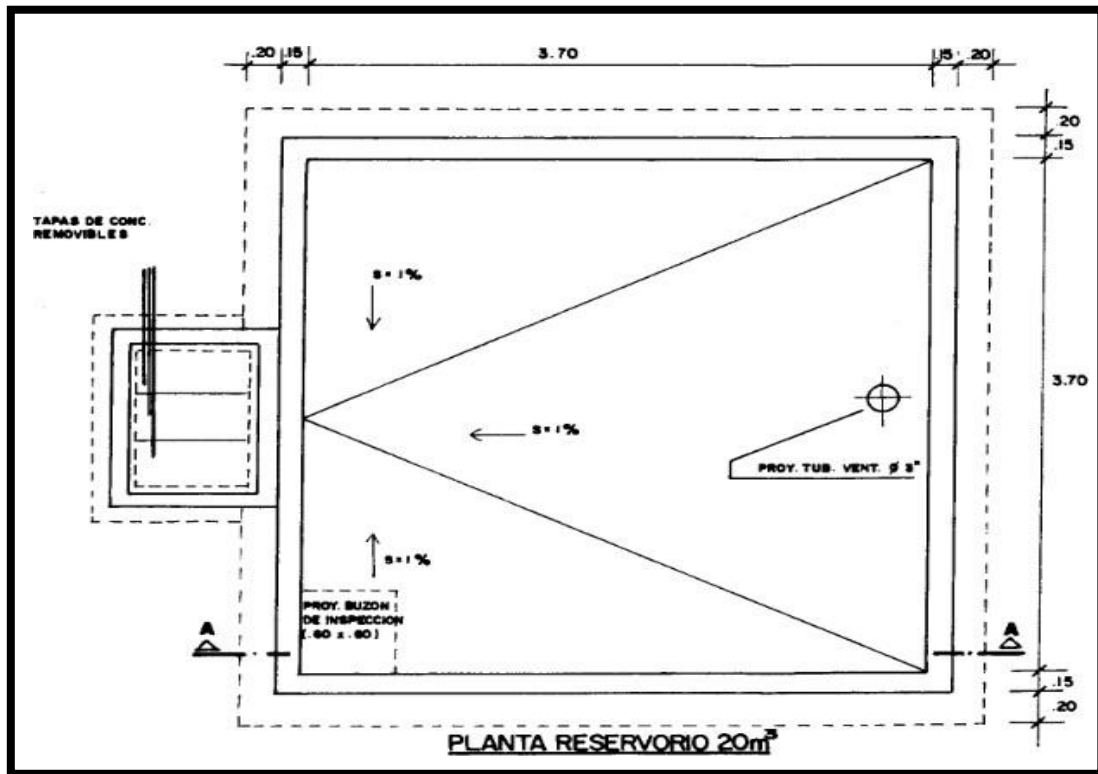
Reservorio Rectangular Apoyado - Vista en Planta
